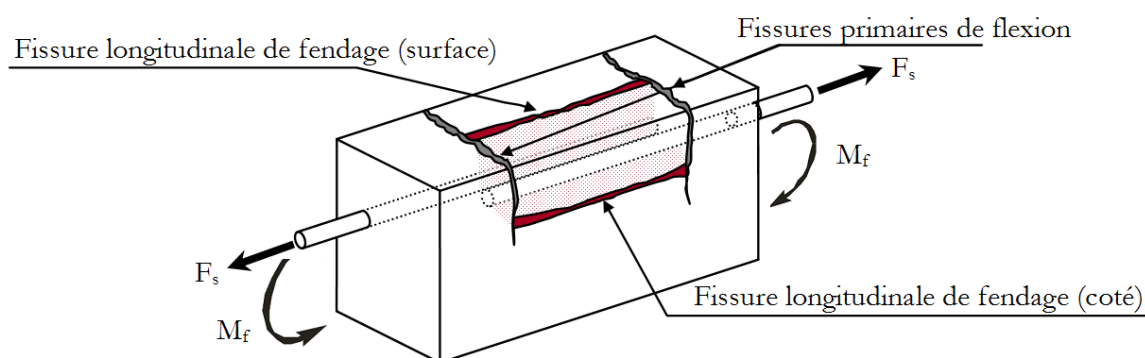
Fissures primaires de flexion et fissures longitudinales de fendage en zone de chevauchement
